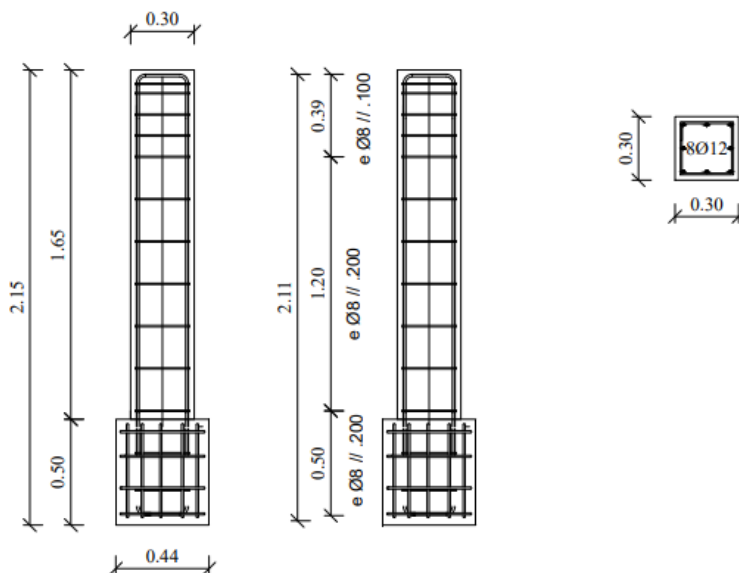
Secção transversal e detalhe das armaduras dos provetes.
